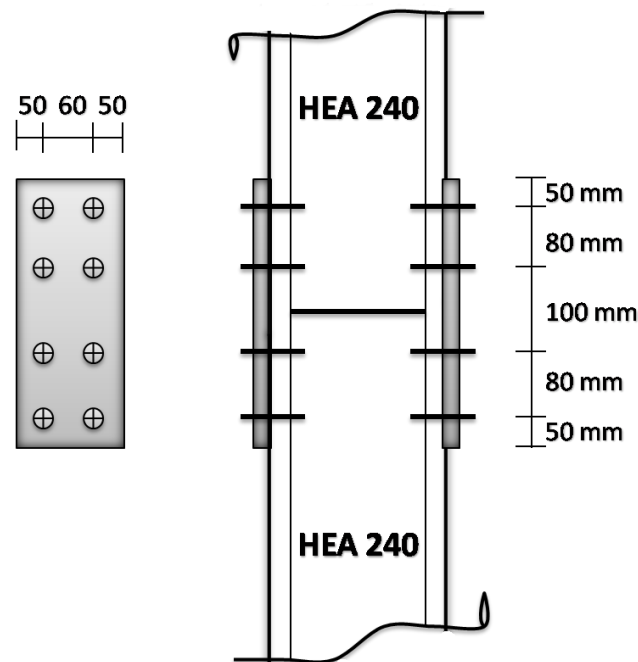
Assemblage poteau-poteau "couvre-joint de la semelle"
